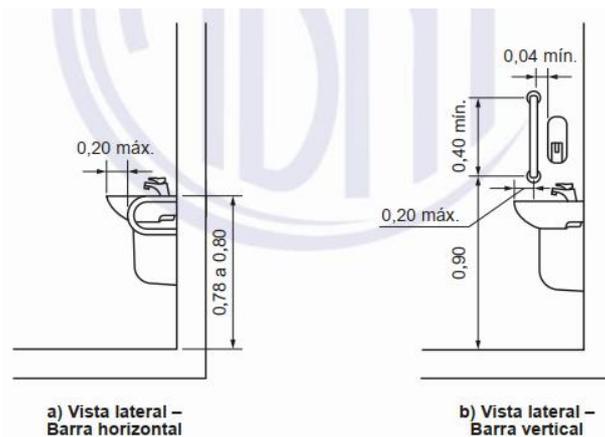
Barra de apoio no lavatório – Vista lateral
